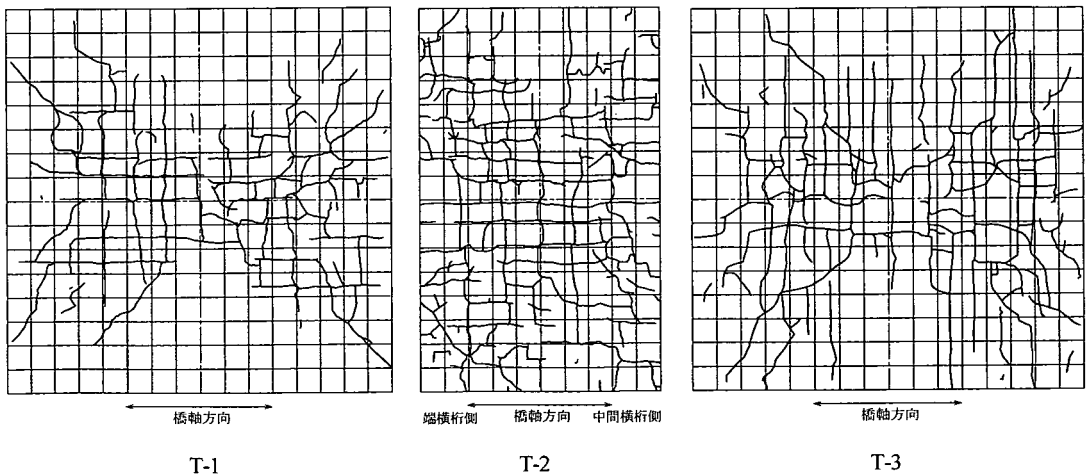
荷重初期(1万回載荷後)における供試体のひび割れ状況
